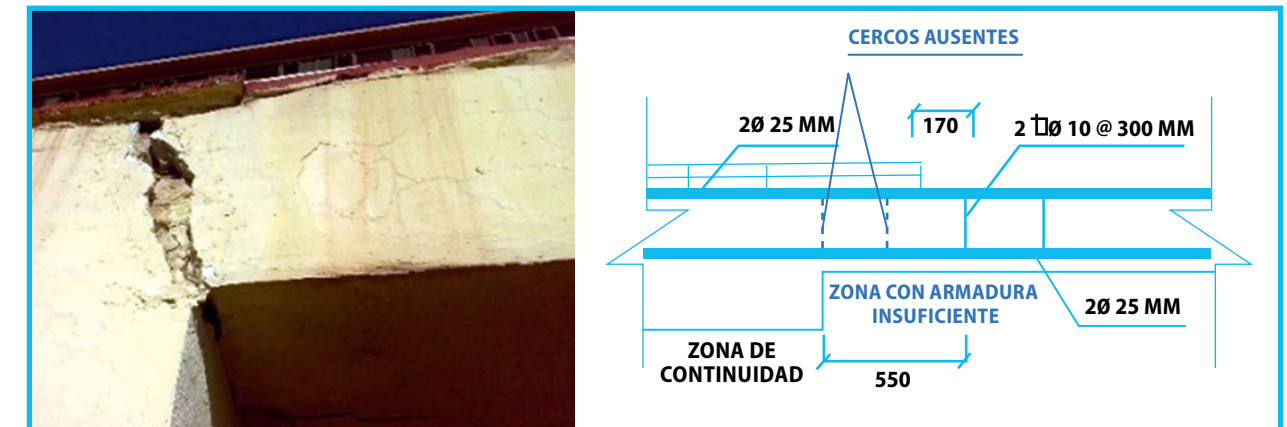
Grieta en zona de empotramiento de la viga de fachada principal del edificio Sierra Maestra, producida por ausencia de cercos y juntas de expansión. Sede de la Corporación CIMEX S. A.
